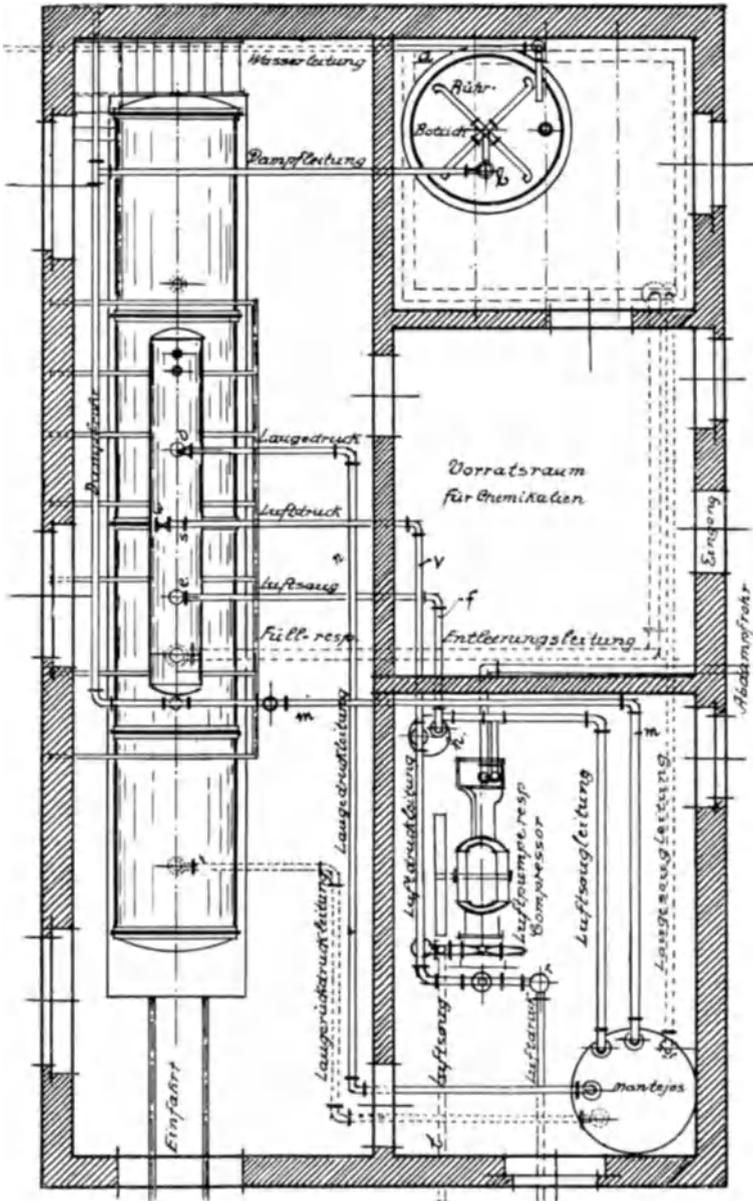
b. Grundriß einer Grubenholz-Imprägnieranlage.
